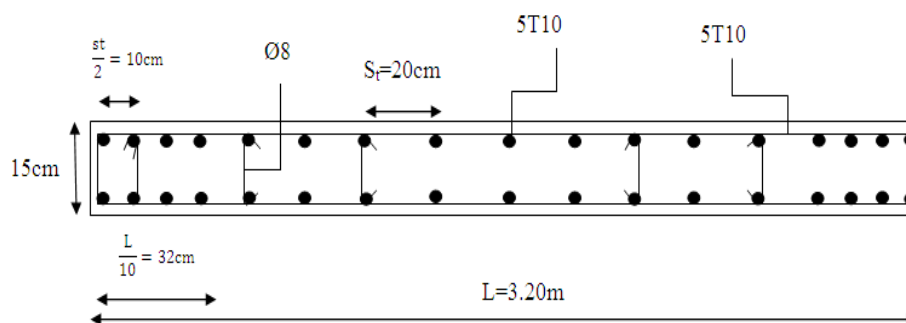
dispositions du ferrailage longitudinal du voile.
